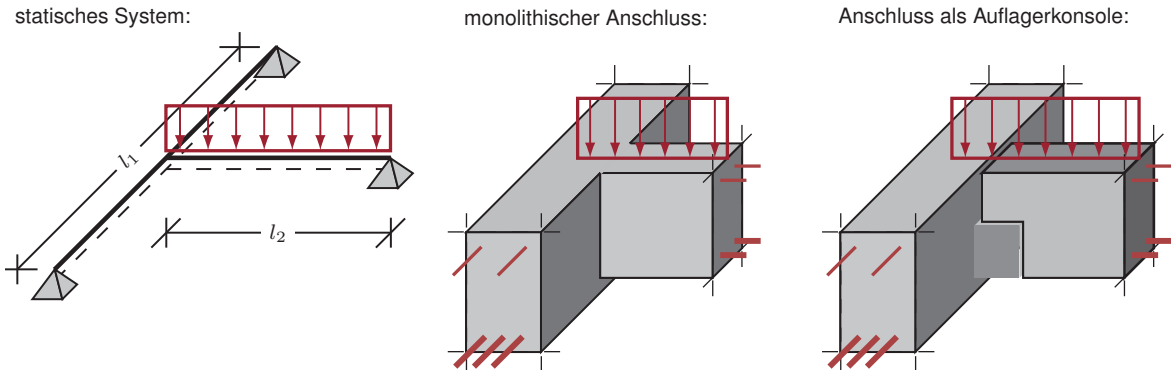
Senkrecht zu seiner Ebene belastetes System mit a: Verträglichkeitstorsion und b: Gleichgewichtstorsion
